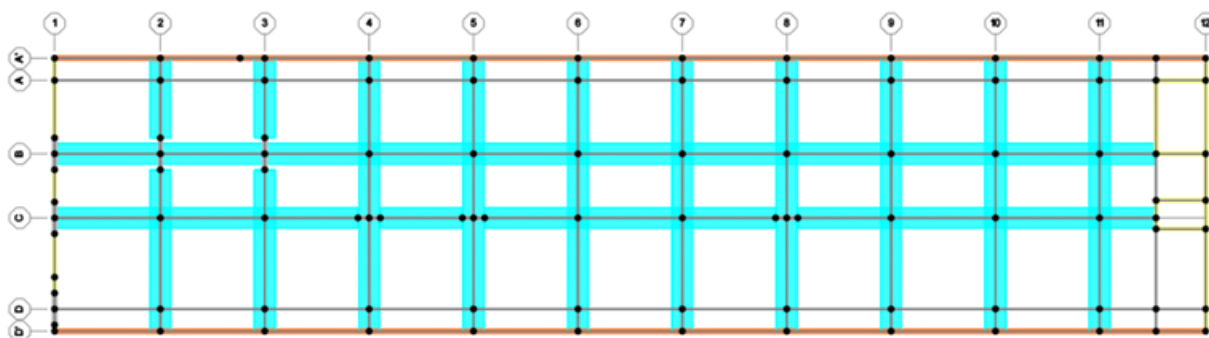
Planta do Piso 2, com as respectivas vigas de bordadura (vermelho) e bandas maciças (azul).
